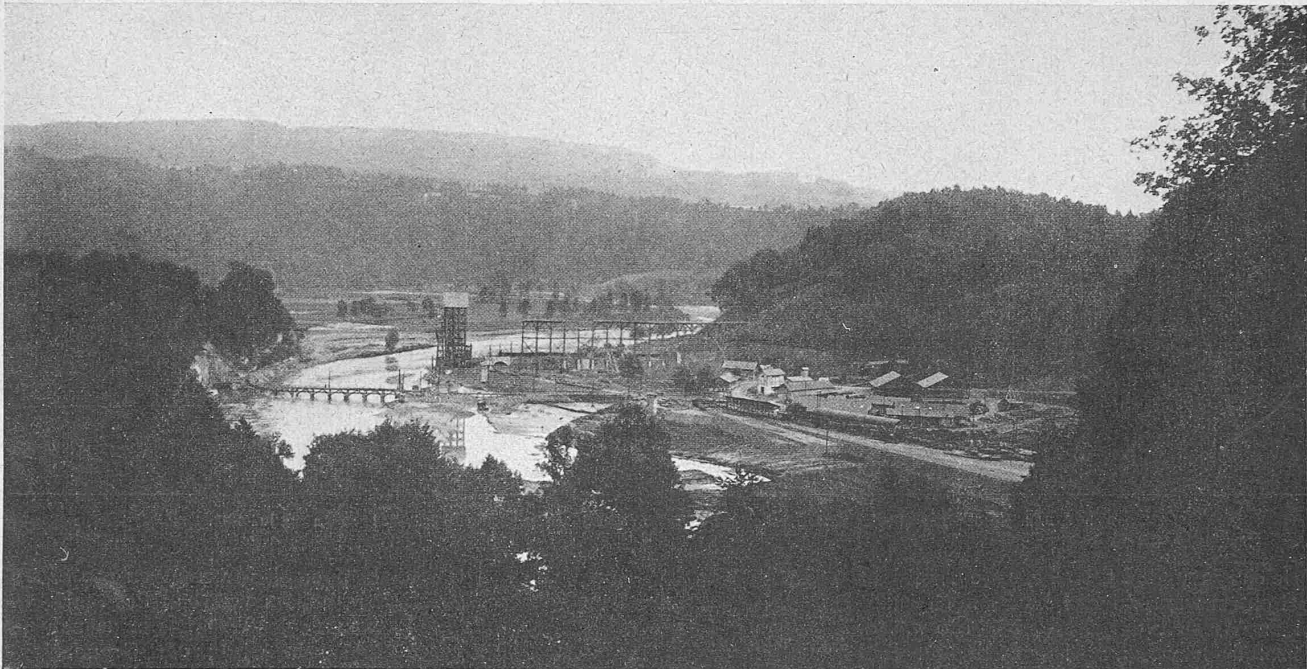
Ansicht der Baustelle der Wasserkraftanlage Mühleberg von Norden (flussaufwärts, vergl. Lageplan) zu Anfang Juli 1918.
